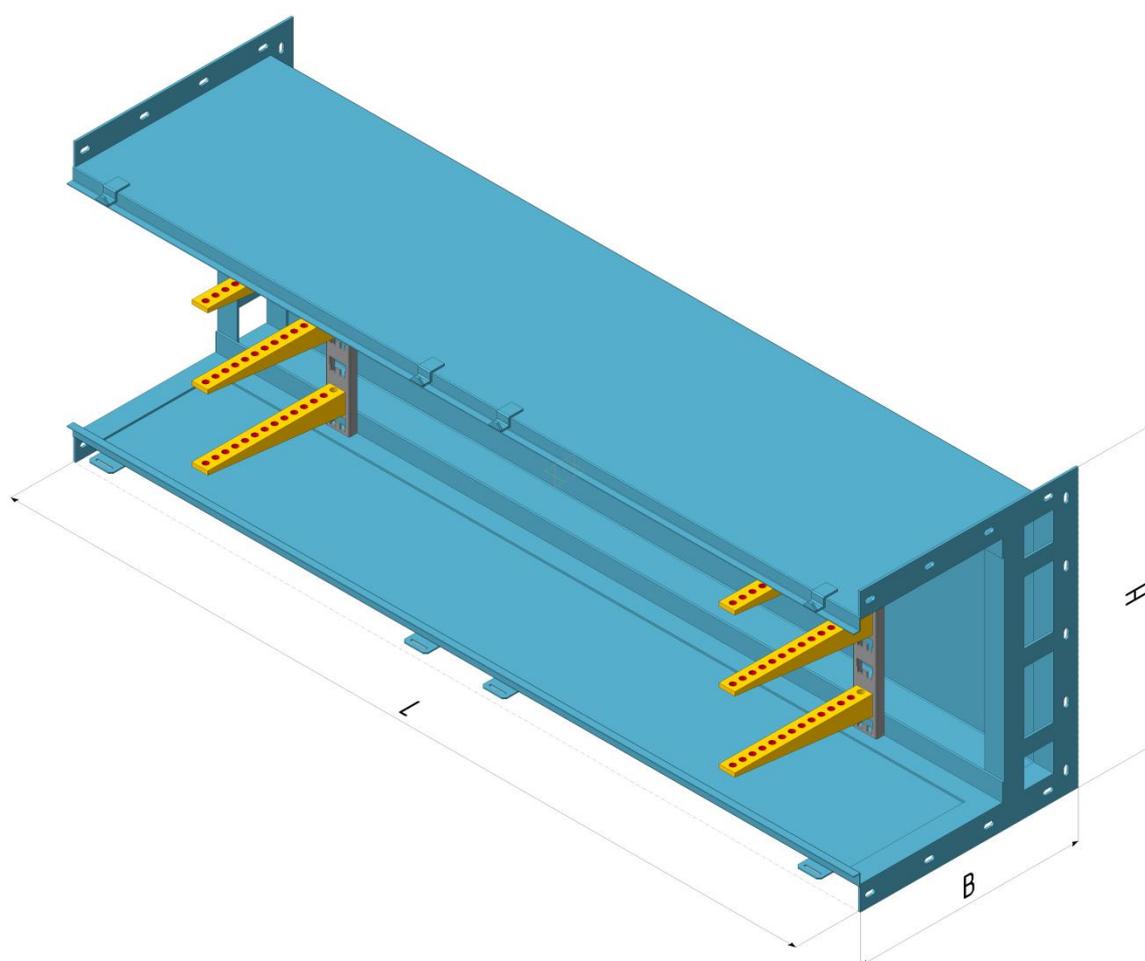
Короб кабельный блочный прямой типа ККБ-П. Общий вид
